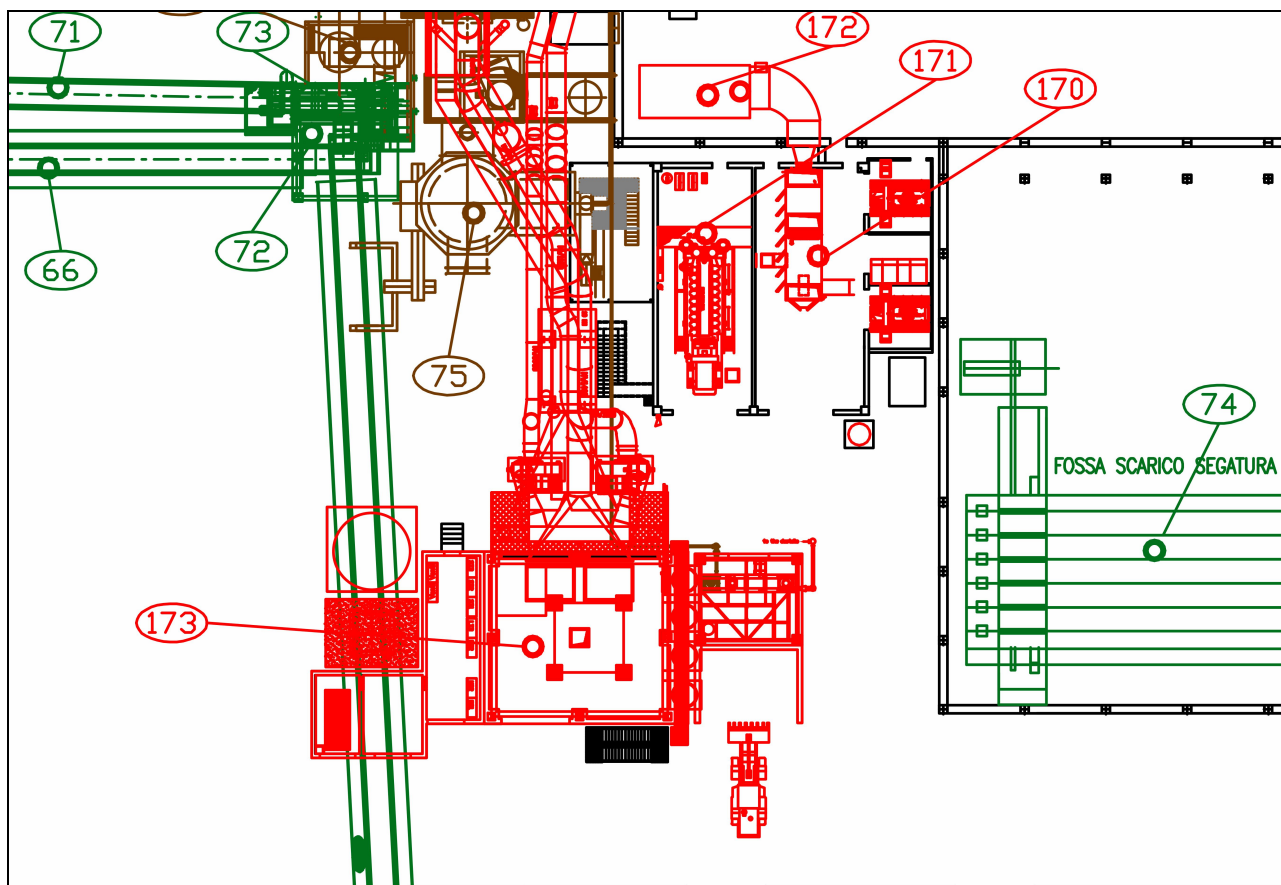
Stralcio progettuale con ubicazione delle prove penetrometriche – Stralcio planimetrico con ubicazione filtro
